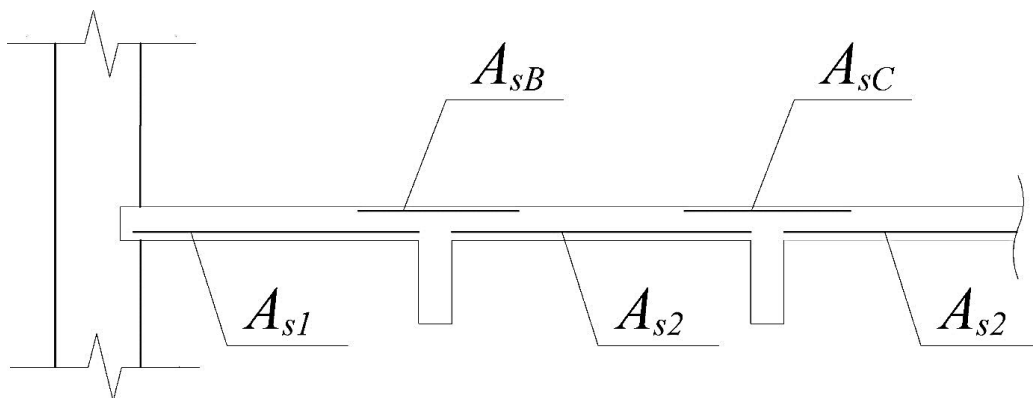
Схема розташування поздовжнього робочого напрямку армування
